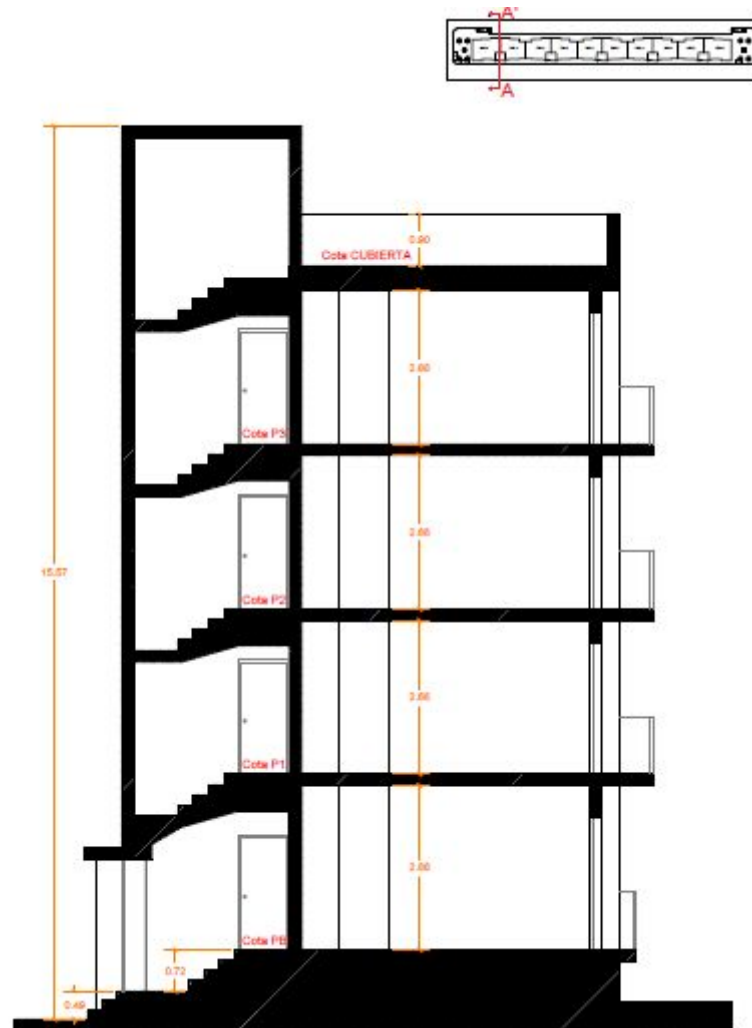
Sección BH Escalera 5 (Fuente: Anejo A)
